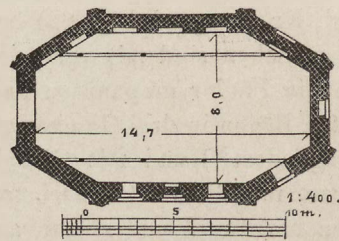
Neuenburg. Grundriss der Kapelle zu St. Georg.
